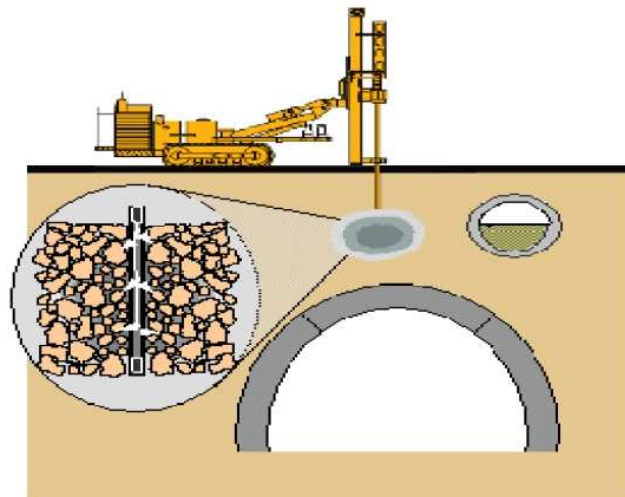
Injection pour l'excavation d'un tunnel (Bouchelaghem, 2001 [13])
